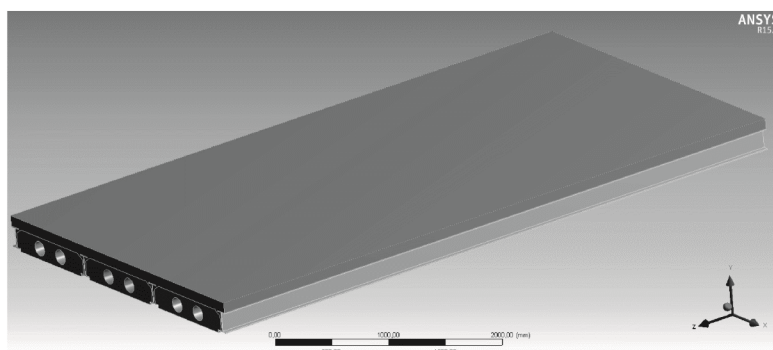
Компьютерная модель сталежелезобетонной плиты с ребрами и легкобетонными вкладышами (показана половина плиты)
